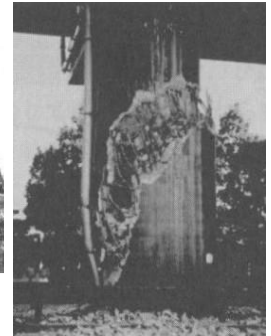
道路橋脚の軸圧縮せん断破壊²⁾
